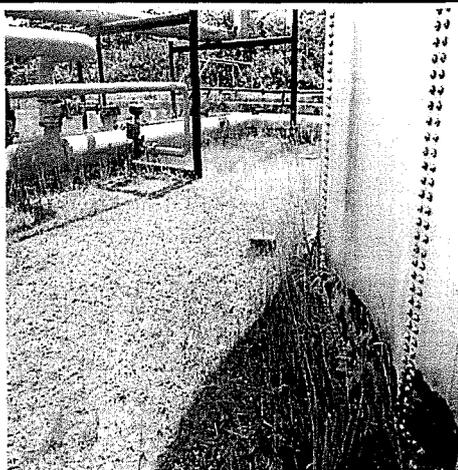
E341448 N9690097 (PSAD 56) / Batería Capahuari Sur
